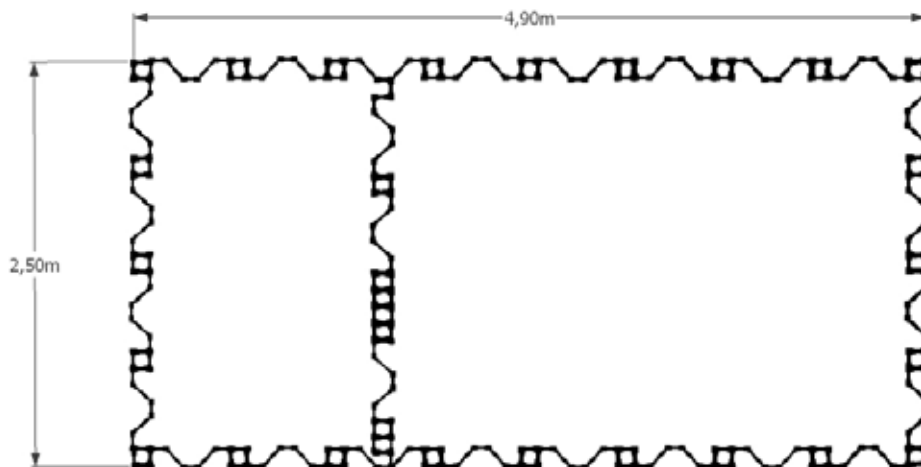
Módulo A. Planta de armado en SIPROMAT: Elaboración propia 2010
